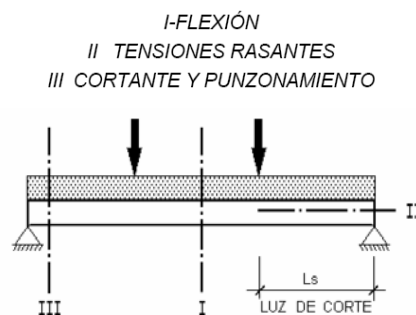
Secciones críticas en un forjado mixto de chapa colaborante.
